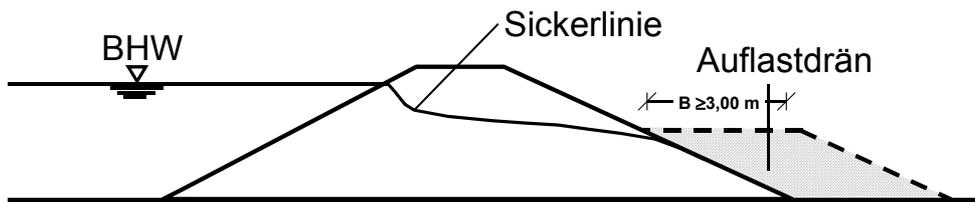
Deichquerschnitt mit Auflastdrän (Anschüttung)
